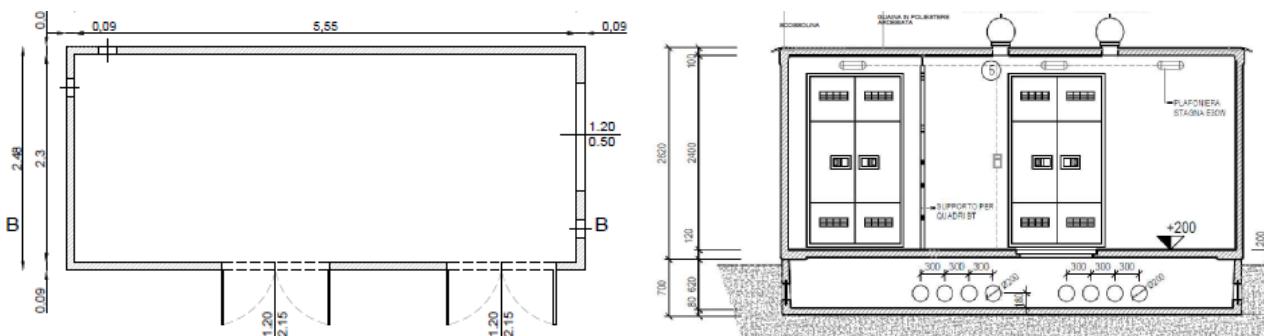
Pianta e prospetto della cabina di sezionamento
